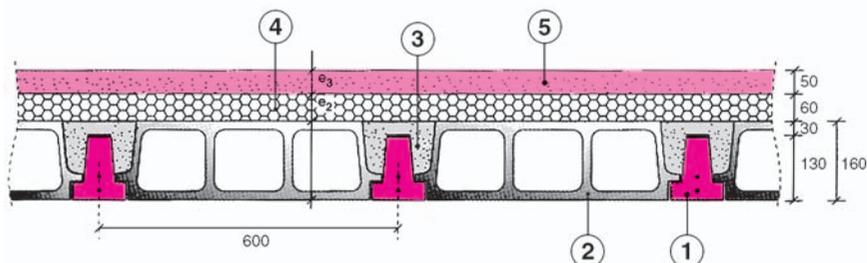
Plancher avec dalle de compression incorporée + dalle flottante
